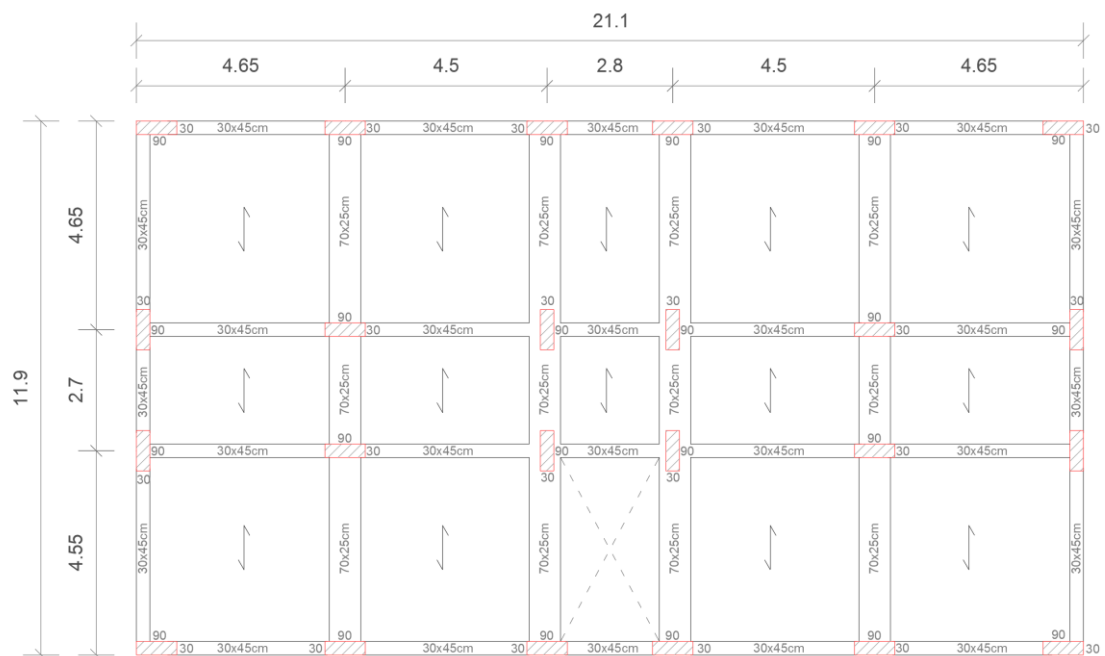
Carpenteria primo solaio struttura in c.a. a tre piani.
